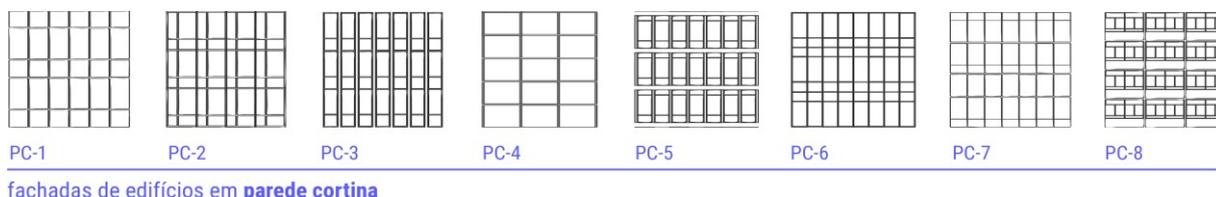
Formas estruturais em fachadas de edifícios em parede cortina
